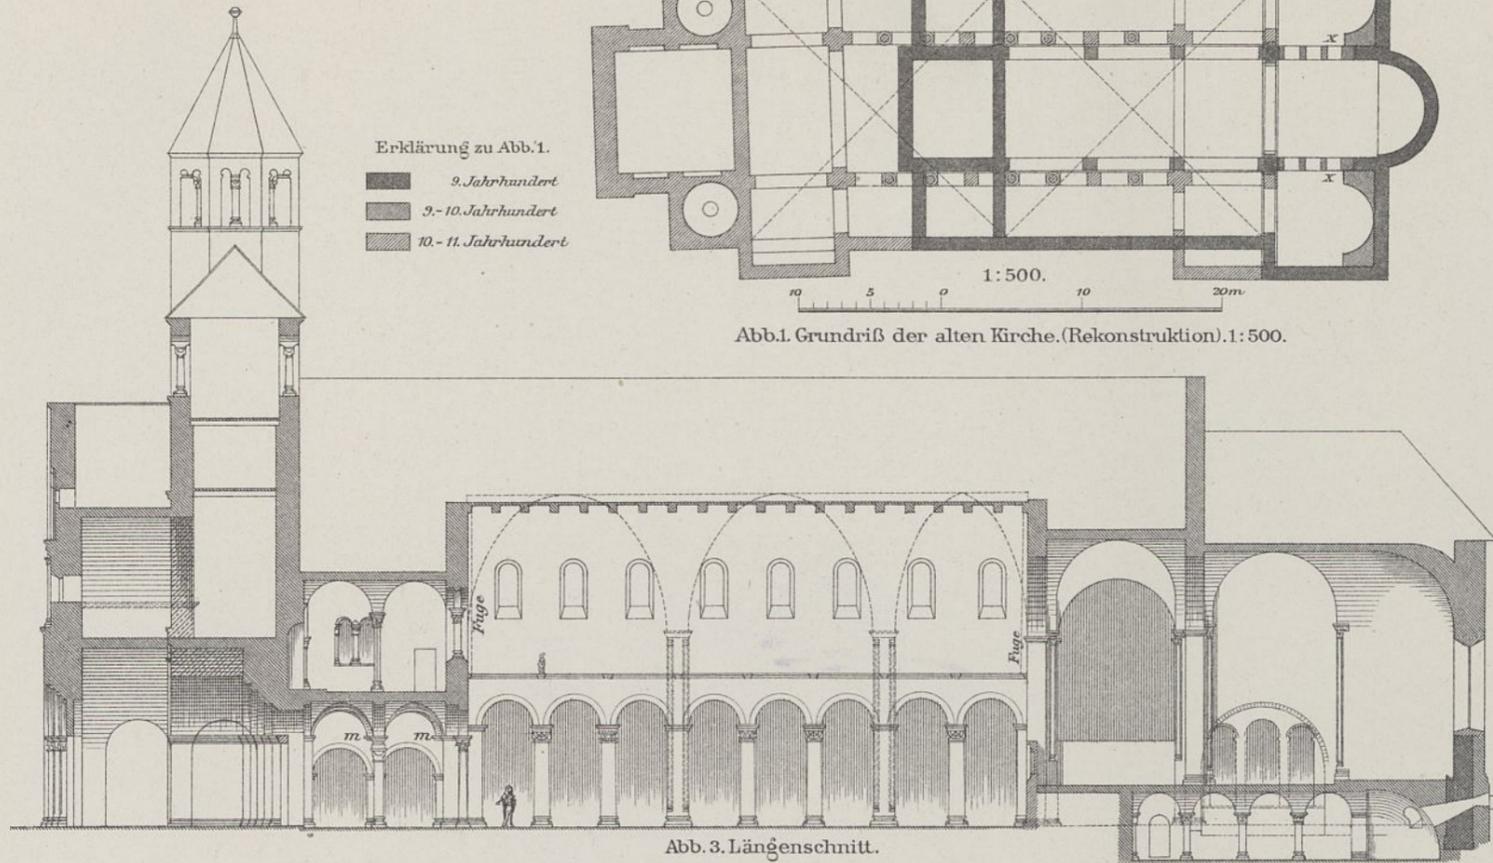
Grundriß der alten Kirche. (Rekonstruktion) 1:500.
